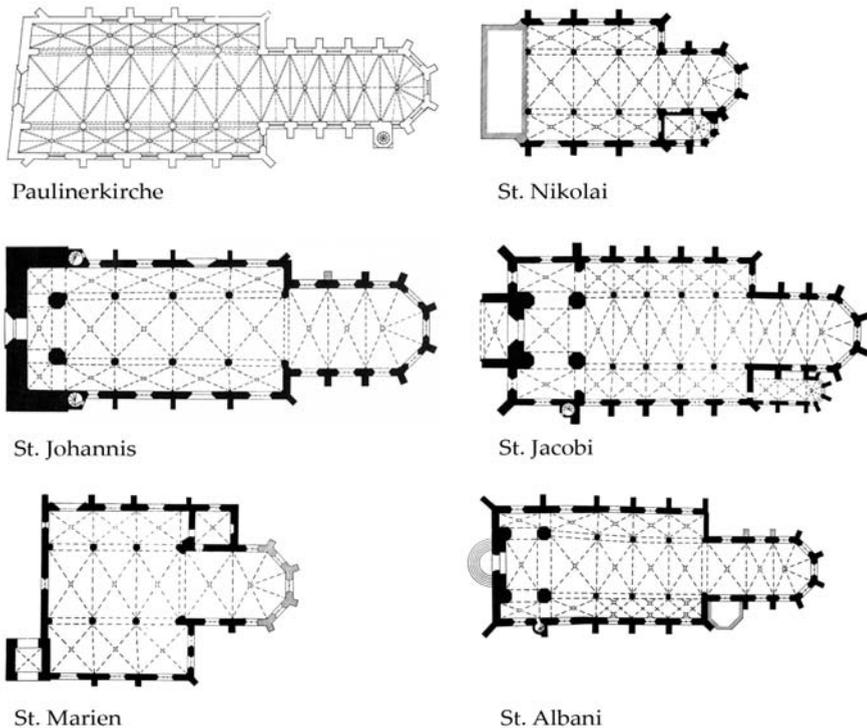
Grundrisse der erhaltenen mittelalterlichen Kirchen Göttingens
